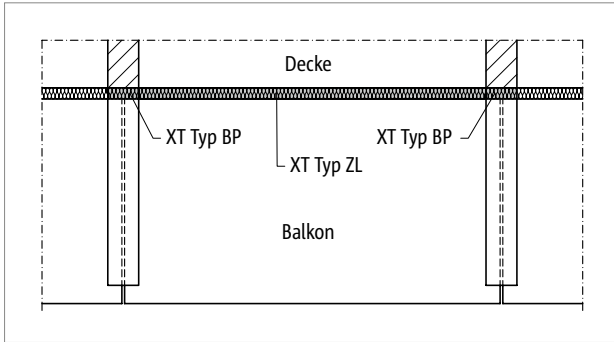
Schöck Isokorb® XT Typ BP: Balkonkonstruktion mit frei auskragenden Unterzügen (Fertigteilbalkon)
